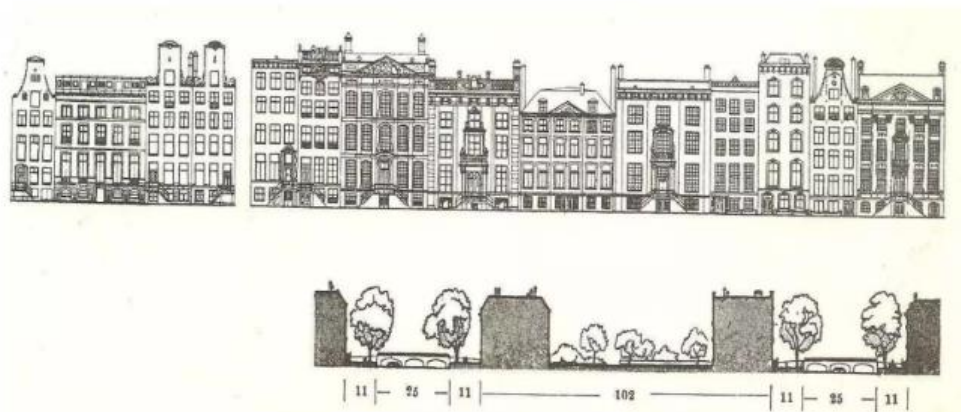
Corte e alçado da disposição dos lotes em Amesterdão.
